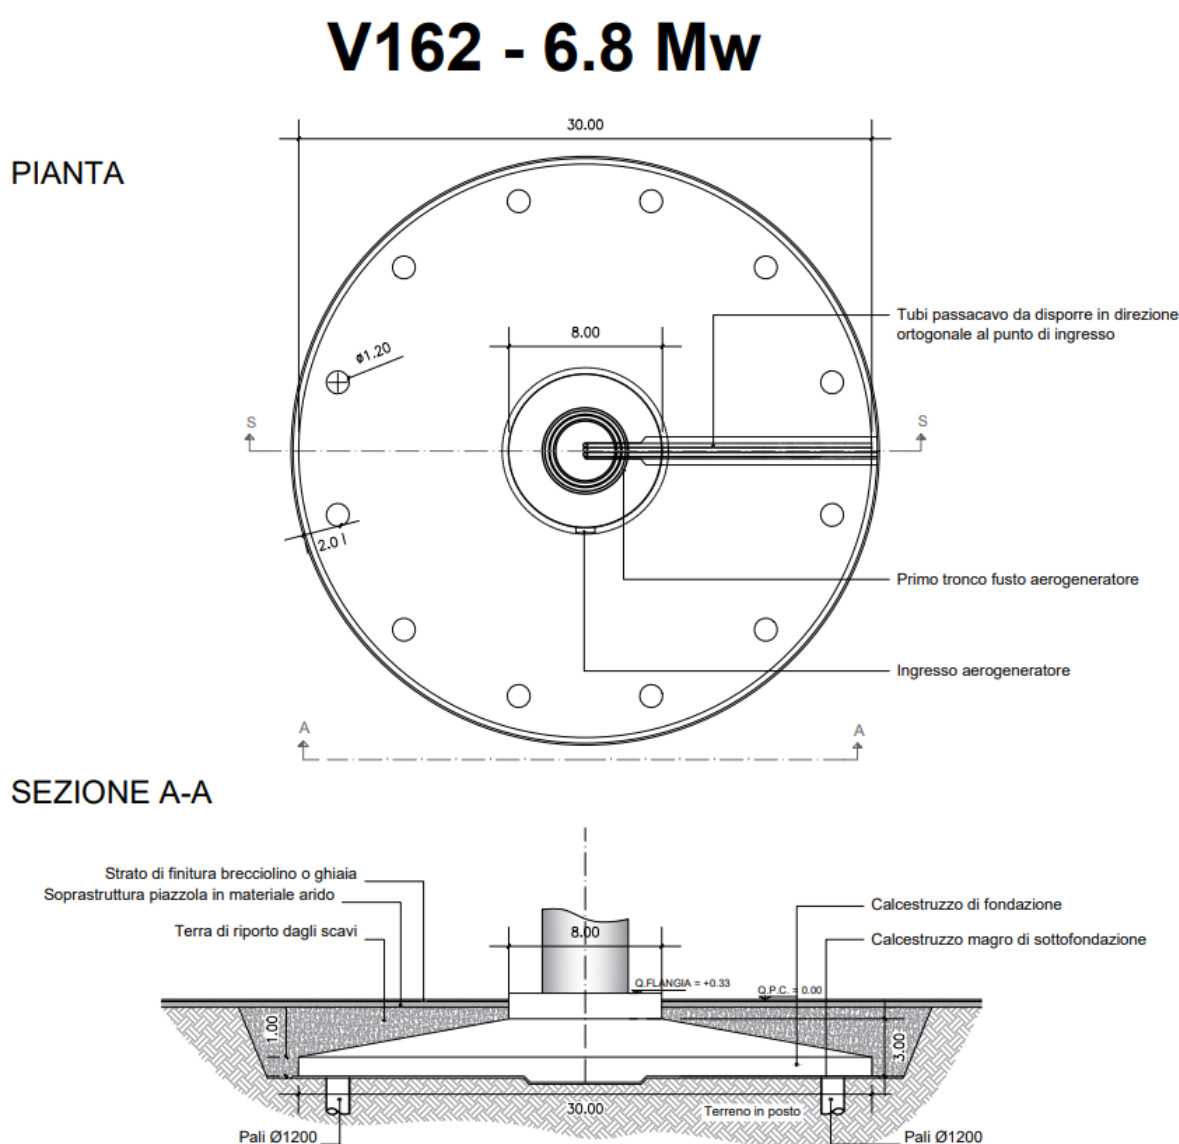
Pianta e sezione tipo fondazioni torre tipologia V162
